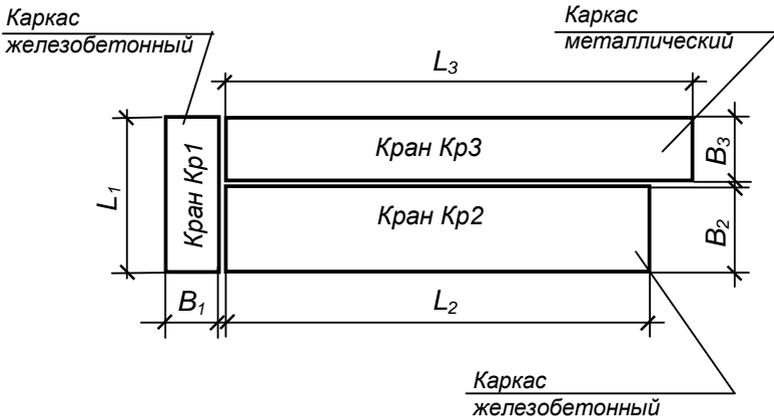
Схема плана промышленного здания на отм. 0,000
